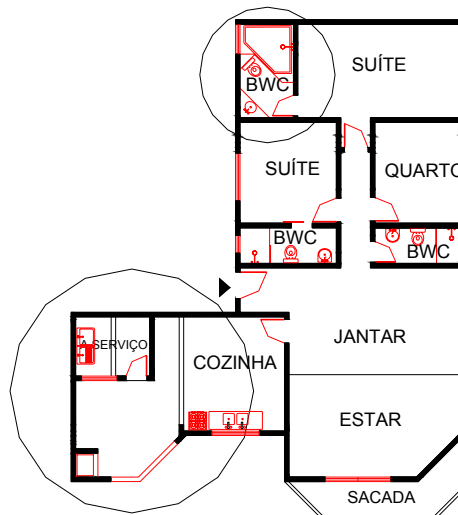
Planta Baixa do apartamento 503 – Estudo de caso B.
